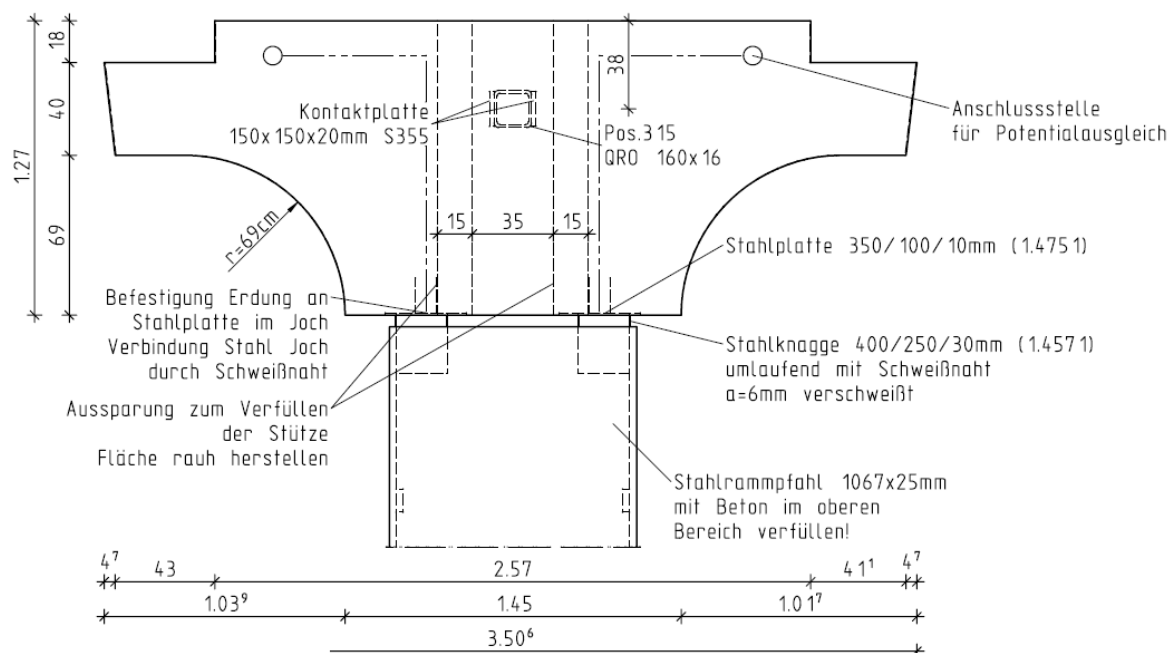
Ansicht Einfachjoch mit vertikaler Betonageöffnung
